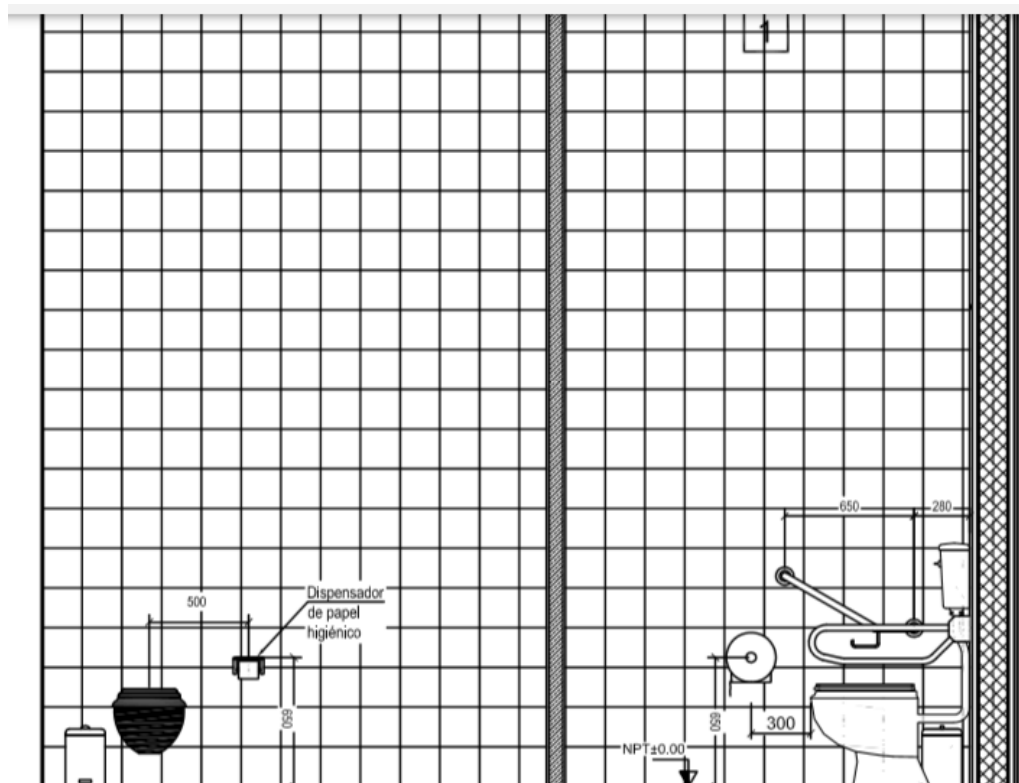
Corte 4. Acabado de revestimiento. Propuesta
